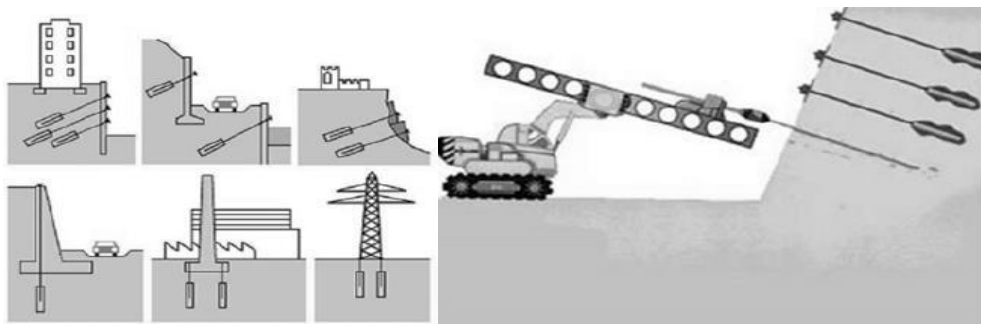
Принципиальная схема устройства грунтовых анкеров
